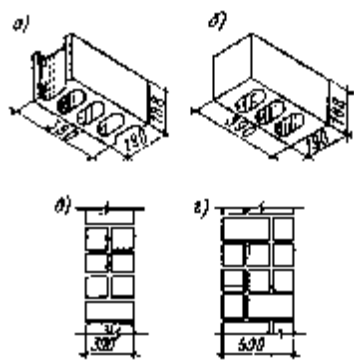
Стены из легкобетонных трехпустотных камней: а – ложковый камень; б – тычковый камень; в – стена в однок камень; г – стена в полтора камня
